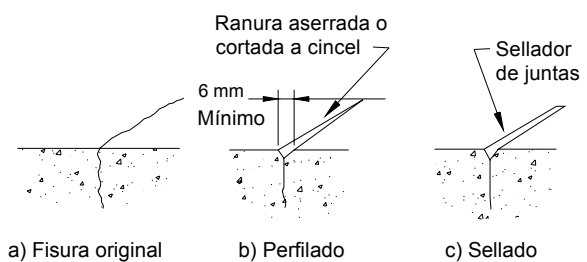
Reparación de una fisura mediante perfilado y sellado (Johnson, 1965)
